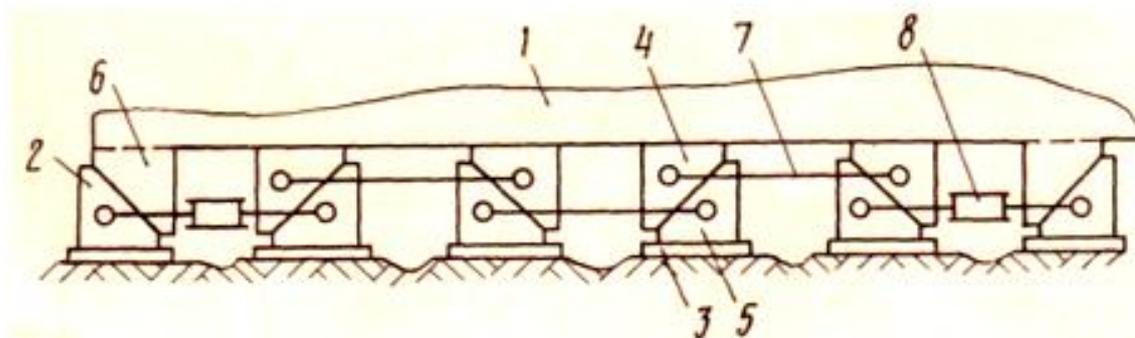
Фундамент будівлі, споруди, що зводиться на основі, що деформується: 1 – надземна частина; 2 - подушка, що переміщається, 3 - основа плити; 4,5 – відповідно верхня та нижня подушка; 6 – кутова подушка; 7,8 – зв'язки
